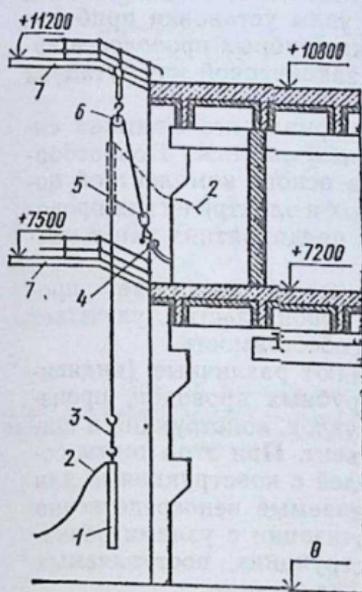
Фрагмент схемы такелажно-транспортных работ (подъем щитов КИП на отметку +7200): 1 — щит, 2 — канат, 3, 4 — стропы, 5 — лебедка, 6 — блок, 7 — площадка котла
